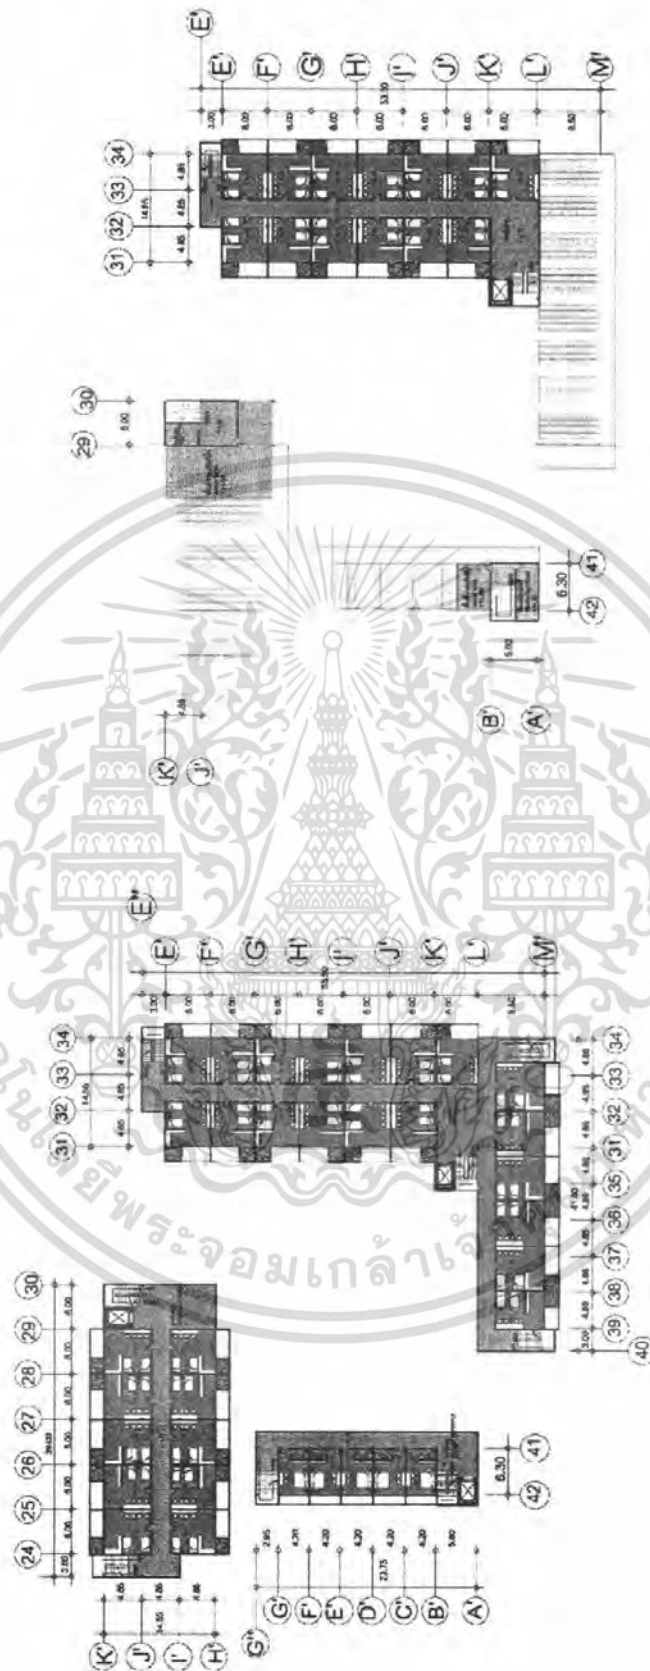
แบบแสดงผังพื้นชั้น 4 (Forth Floor Plan)
